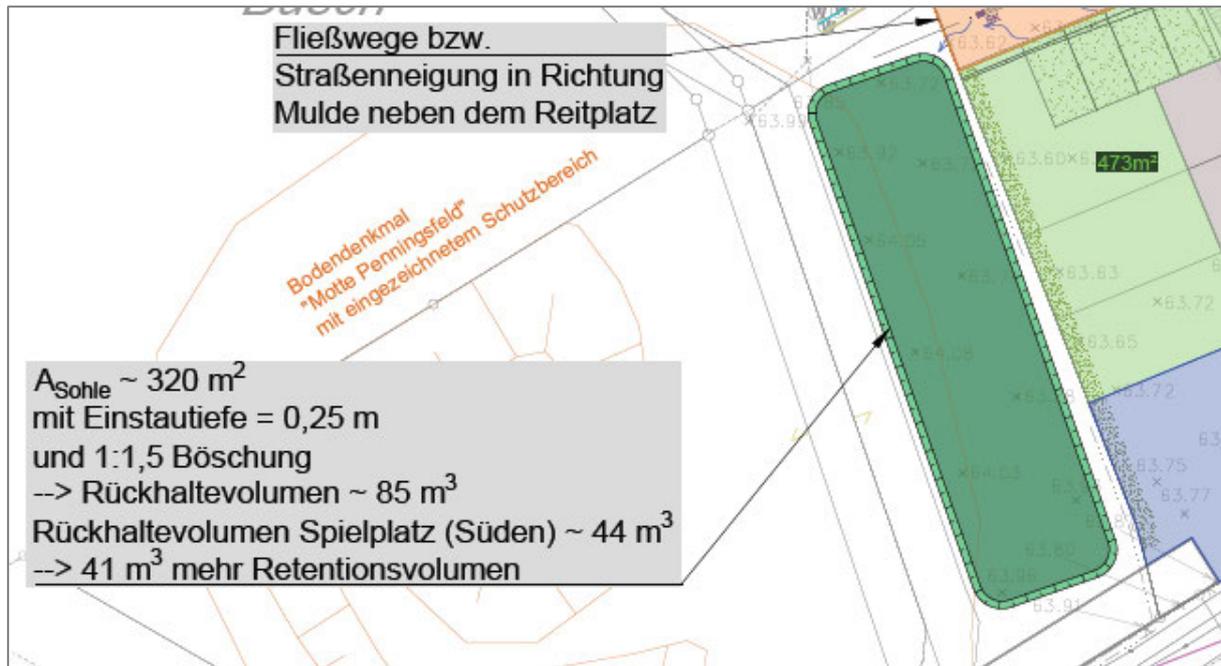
Ausschnitt aus Lageplan zu Planvariante 2 mit geplanter Mulde (Quelle: ConKav Architekten)
